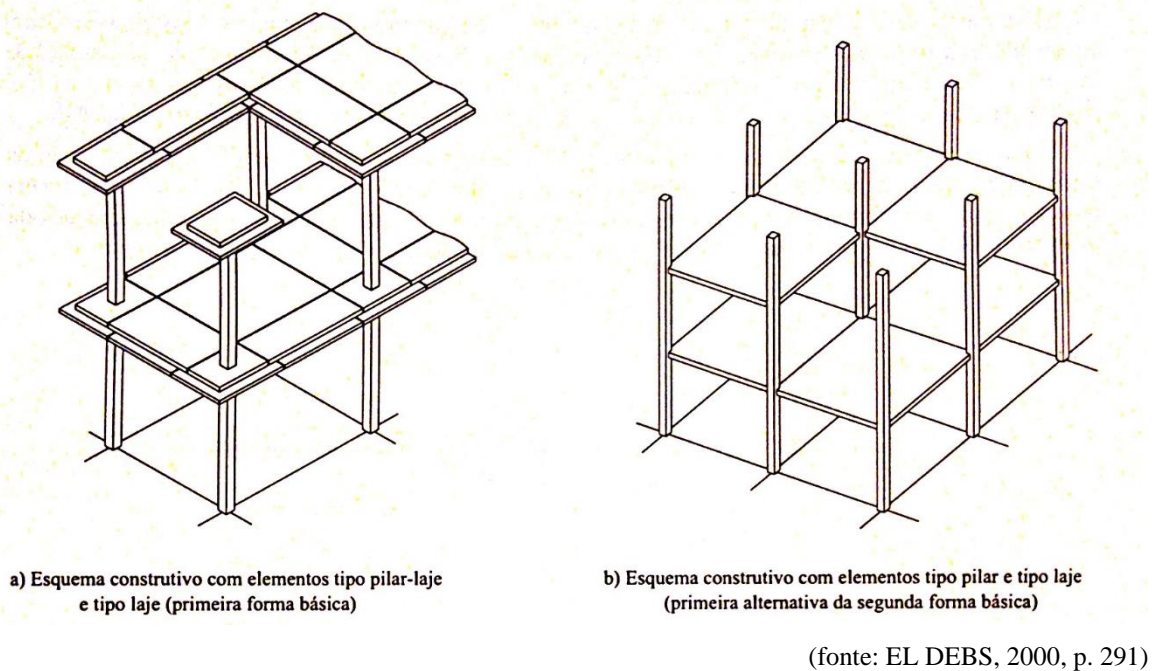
Esquema construtivo com sistemas estruturais de pavimentos sem vigas
